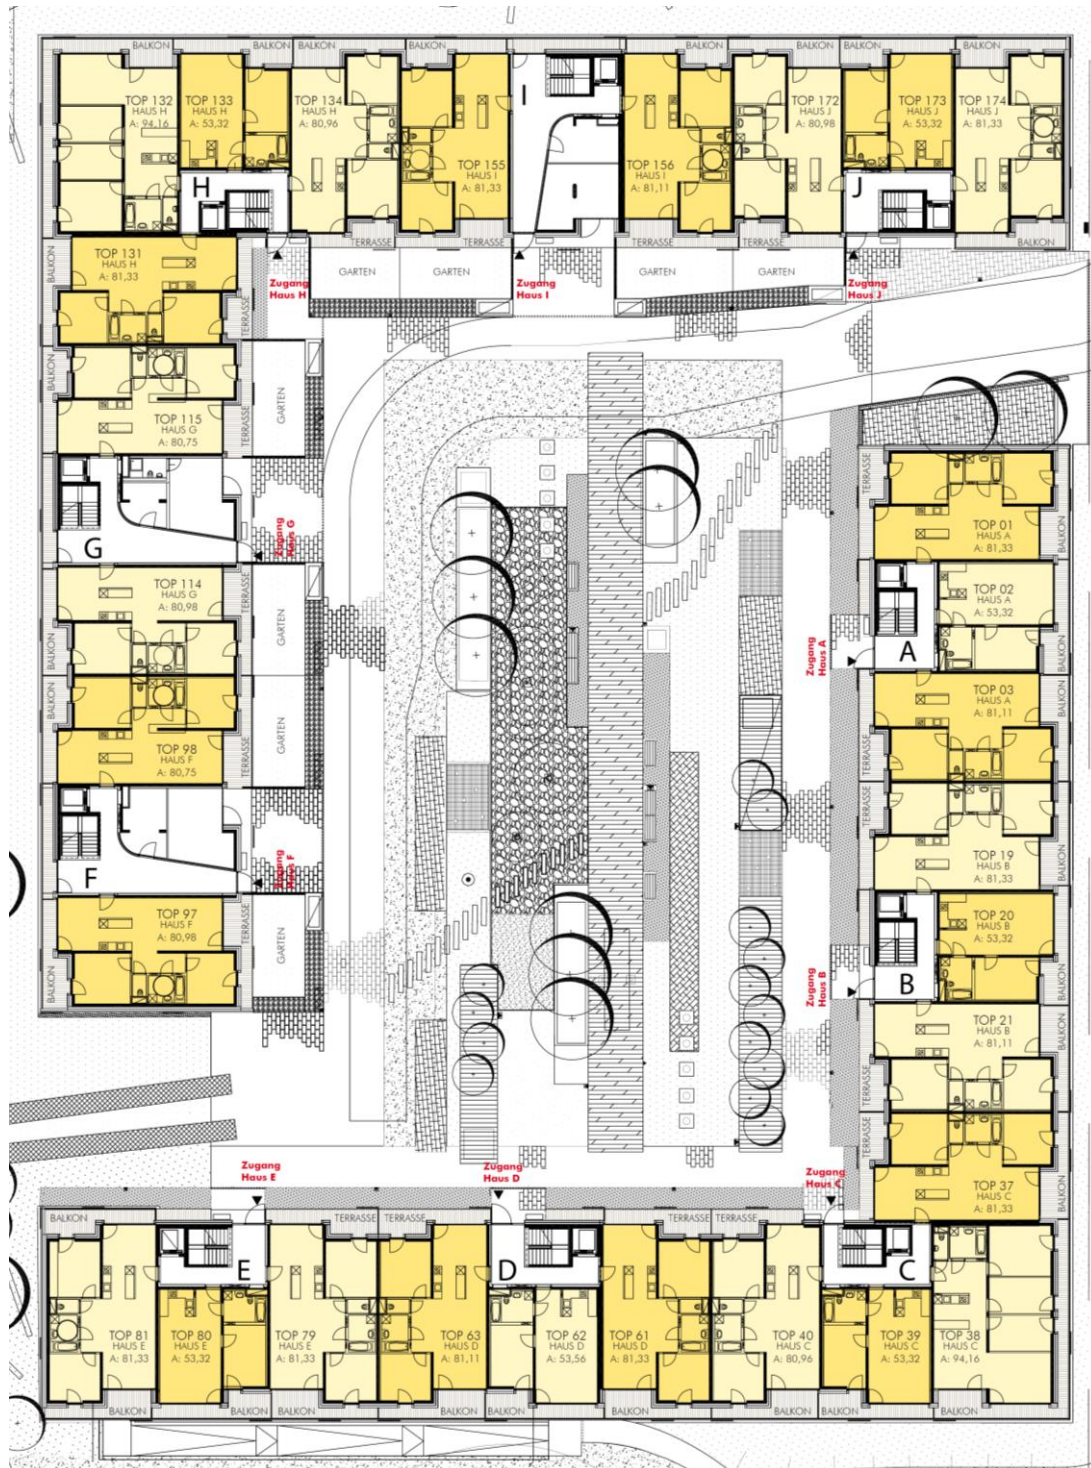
Grundriss Erdgeschoß des betrachteten Komplexes (Neue Heimat Tirol, 2008)
